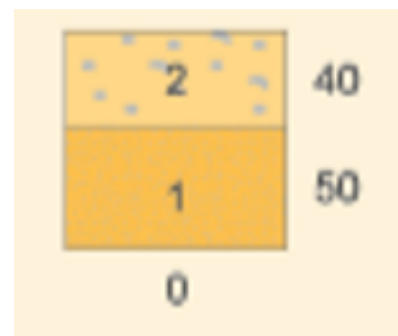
Explanada en Cretácico. Fuente: Instrucción 6.1 – IC. Ministerio de Fomento.
